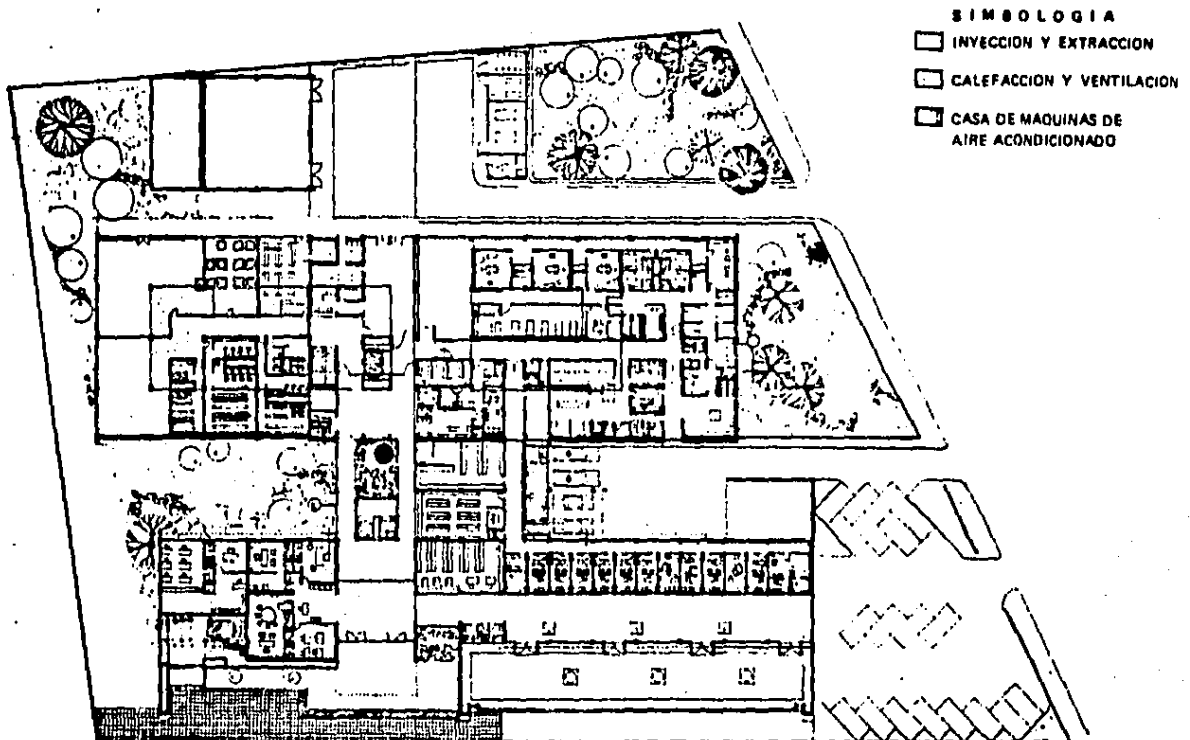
Planta Arquitectónica de Hospital General de Zona con aire acondicionado.
